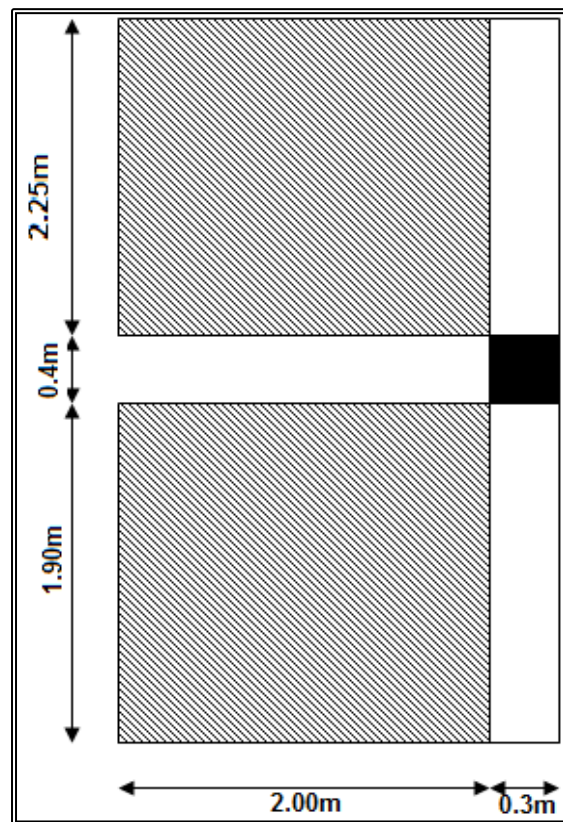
Croquis d'un poteau de rive (C-2)
